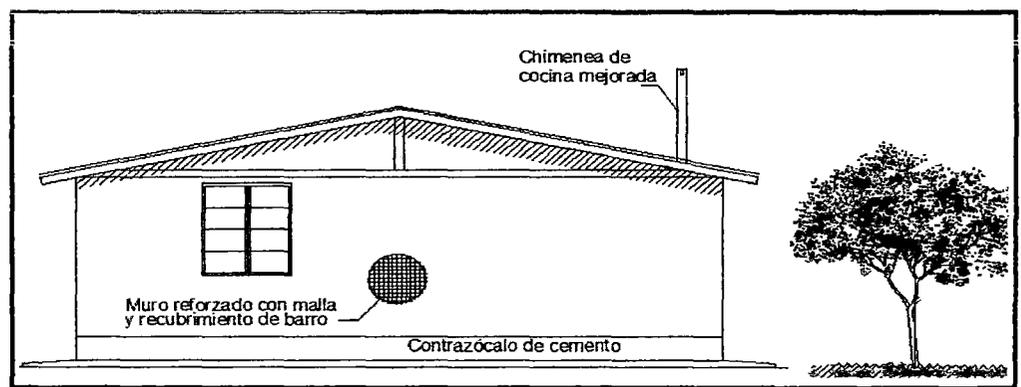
Elevación Lateral de una construcción de adobe terminada
